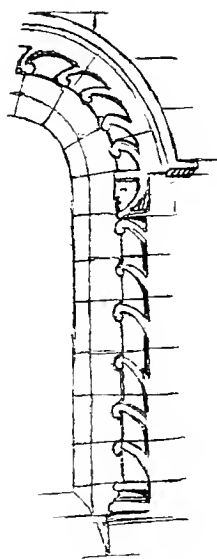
Fenêtre de façade. Coudun (Oise).
